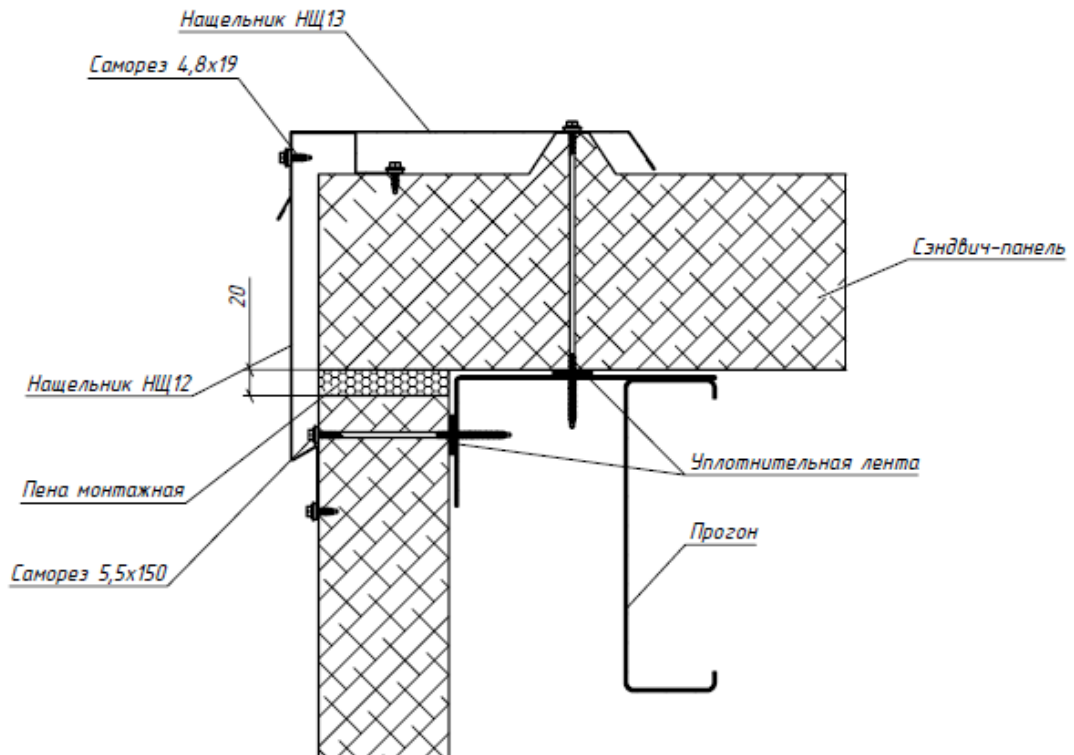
Узел соединения покрытия кровли и покрытия стен из сэндвич-панелей
